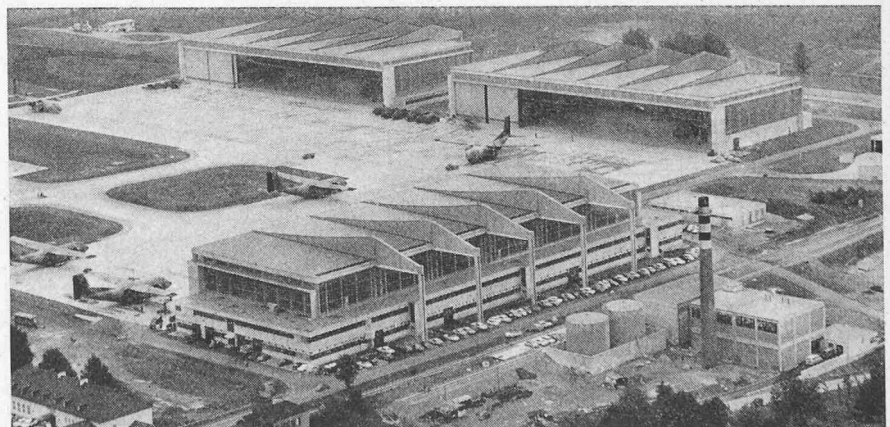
Flugzeughallen Landsberg, Kragbalken aus Spannleichtbeton mit 46 m Spannweite. Grundfläche je Halle: 46 x 120 m, lichte Höhe: 18 m, Torlänge: 120 m
